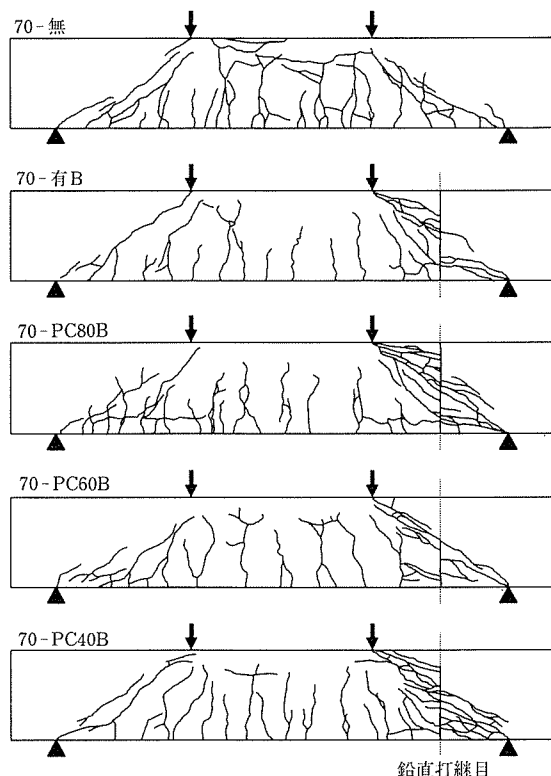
ひび割れの発生状況（高強度コンクリート梁）
